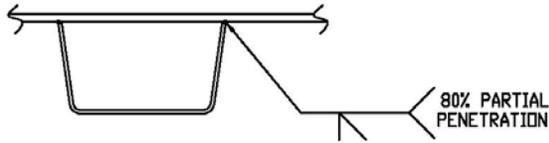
Soudage pour des auge trapézoïdales
